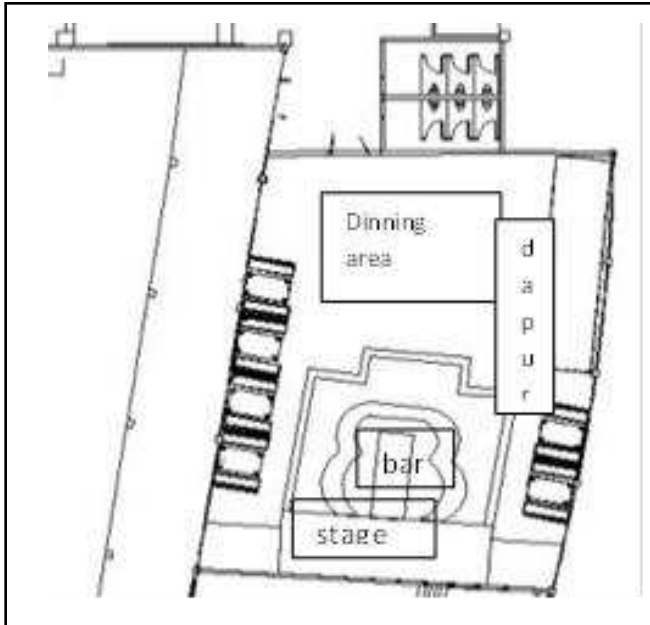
Layout dan skematik desain ruang pertunjukan.
